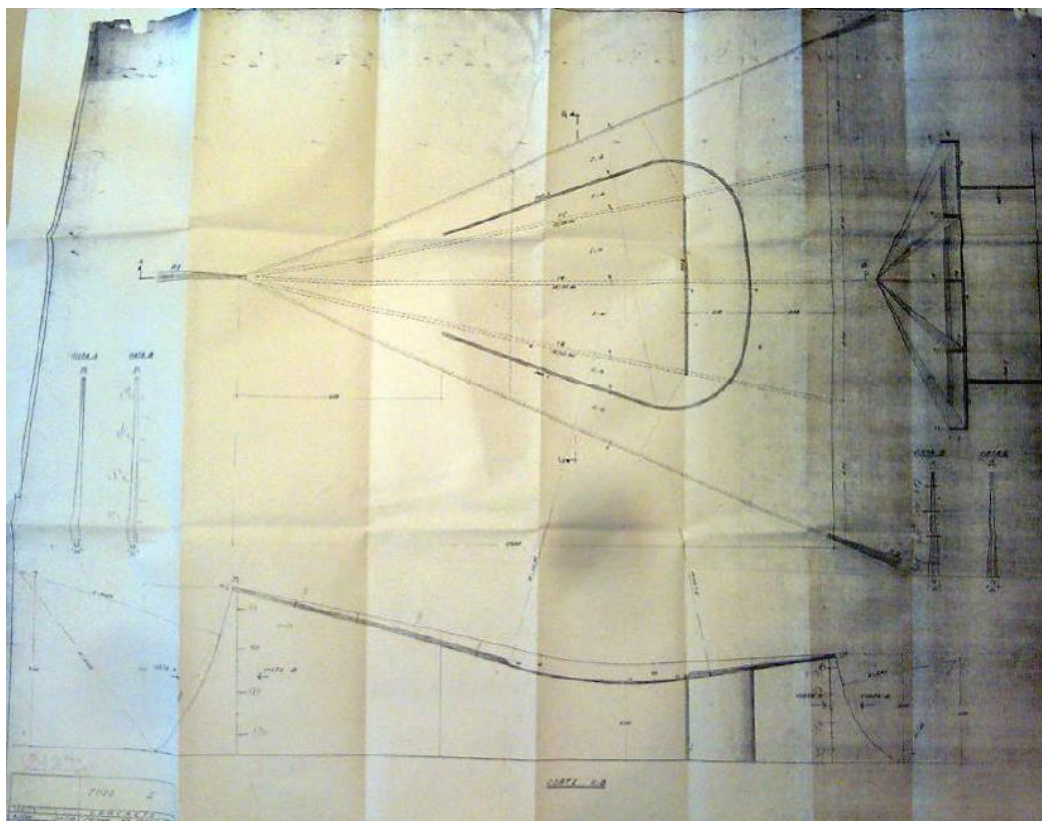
Cópia da planta e de cortes da estrutura da Igreja Nossa Senhora de Fátima.
